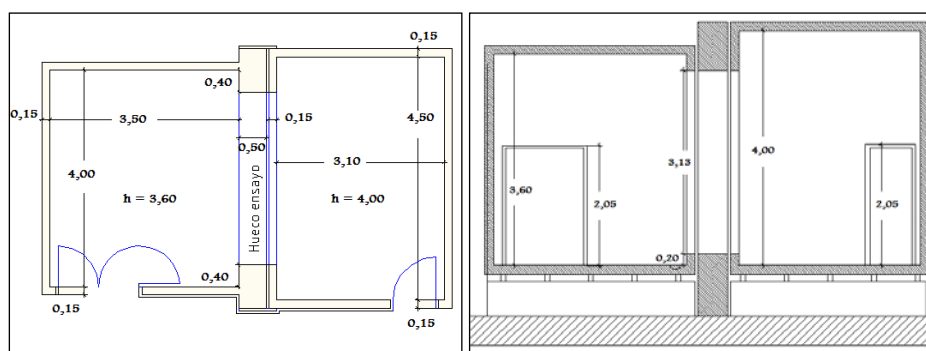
Planta y alzado de la cámara de transmisión horizontal
